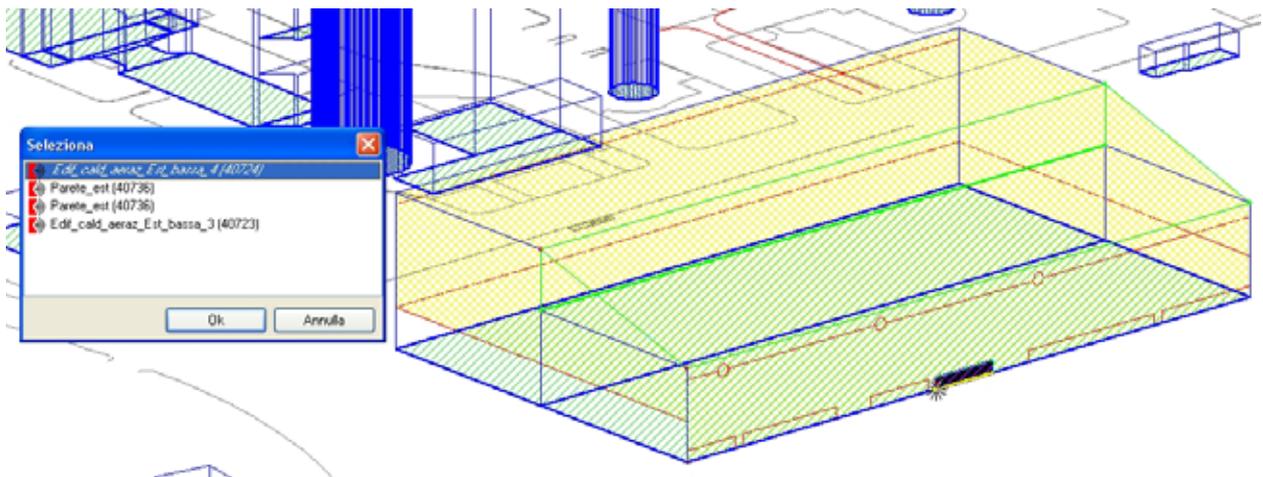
Nuovo edificio generatori di calore, porzione 4 ventilazione parete Est.
